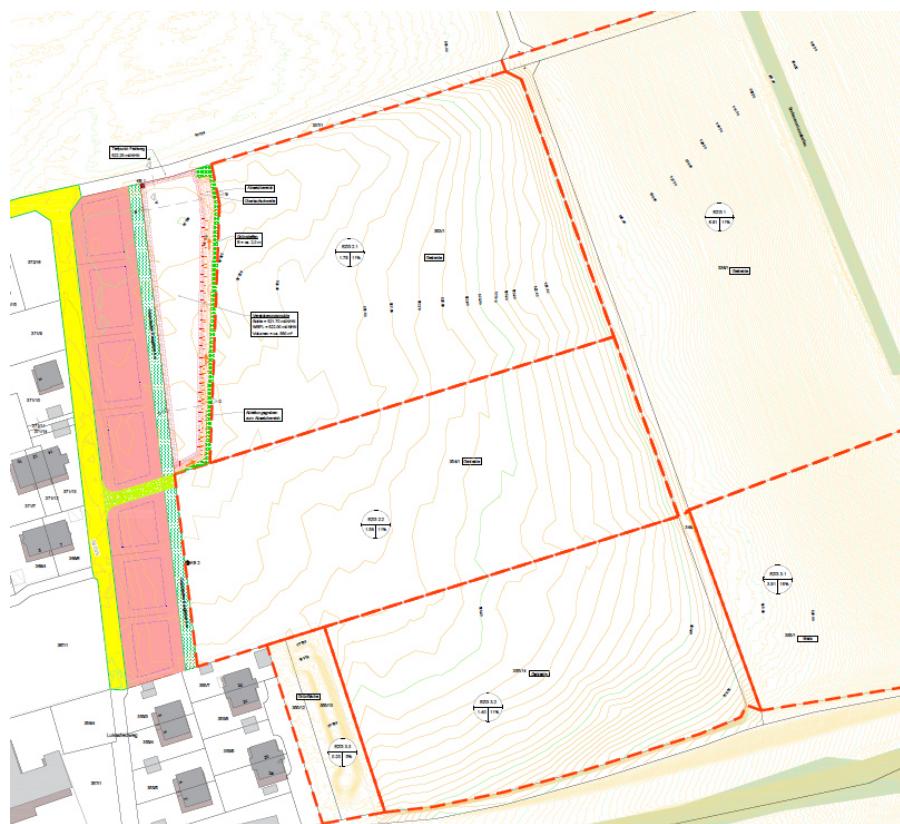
Lageplan Sickerbecken am Baugebiet, Variante Flächenversickerung, Dr. Blasy – Dr. Øverland, beratende Ingenieure GmbH & Co. KG, 16.09.2024
